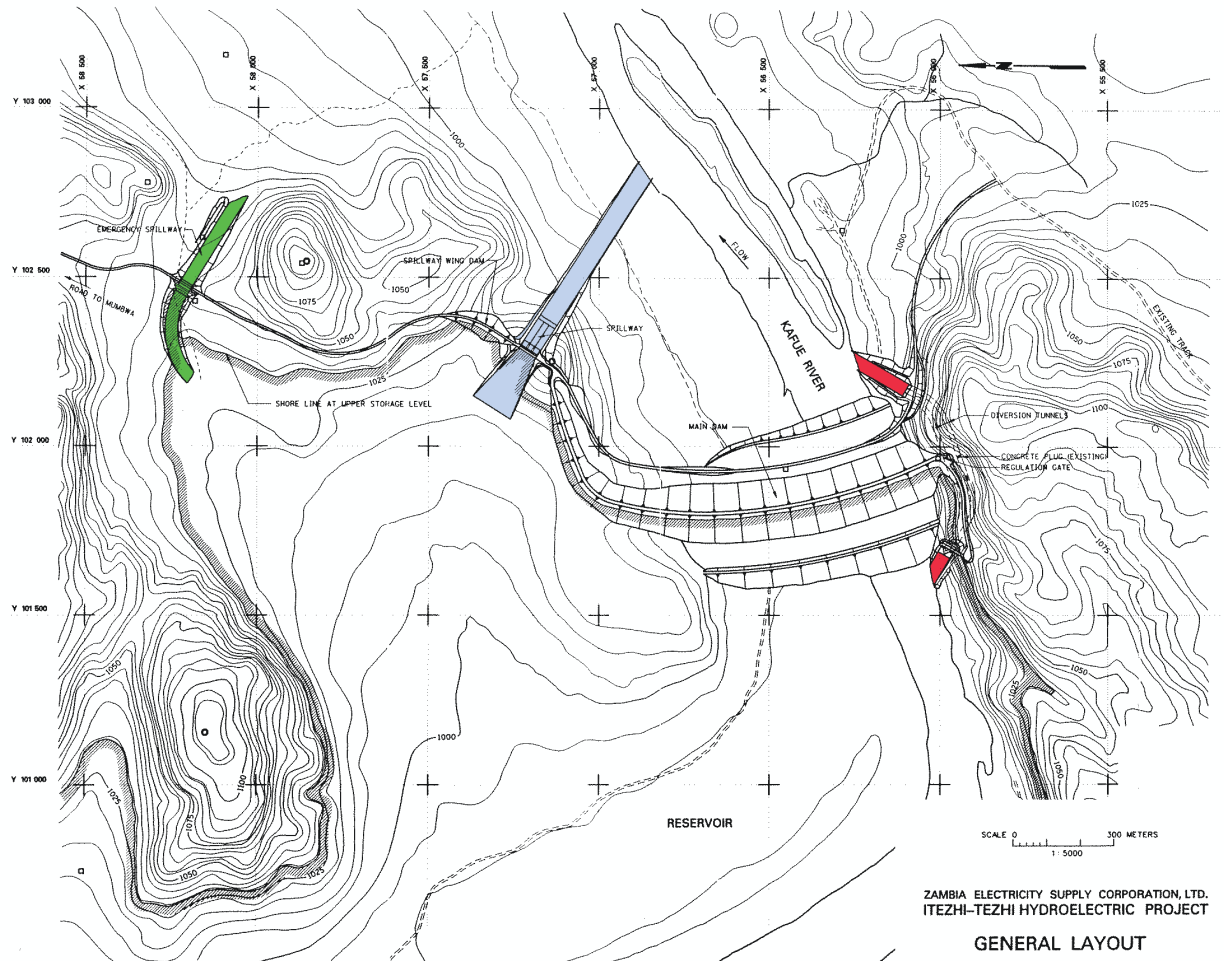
Planimetria della diga di Itezhi-tezhi [23].
